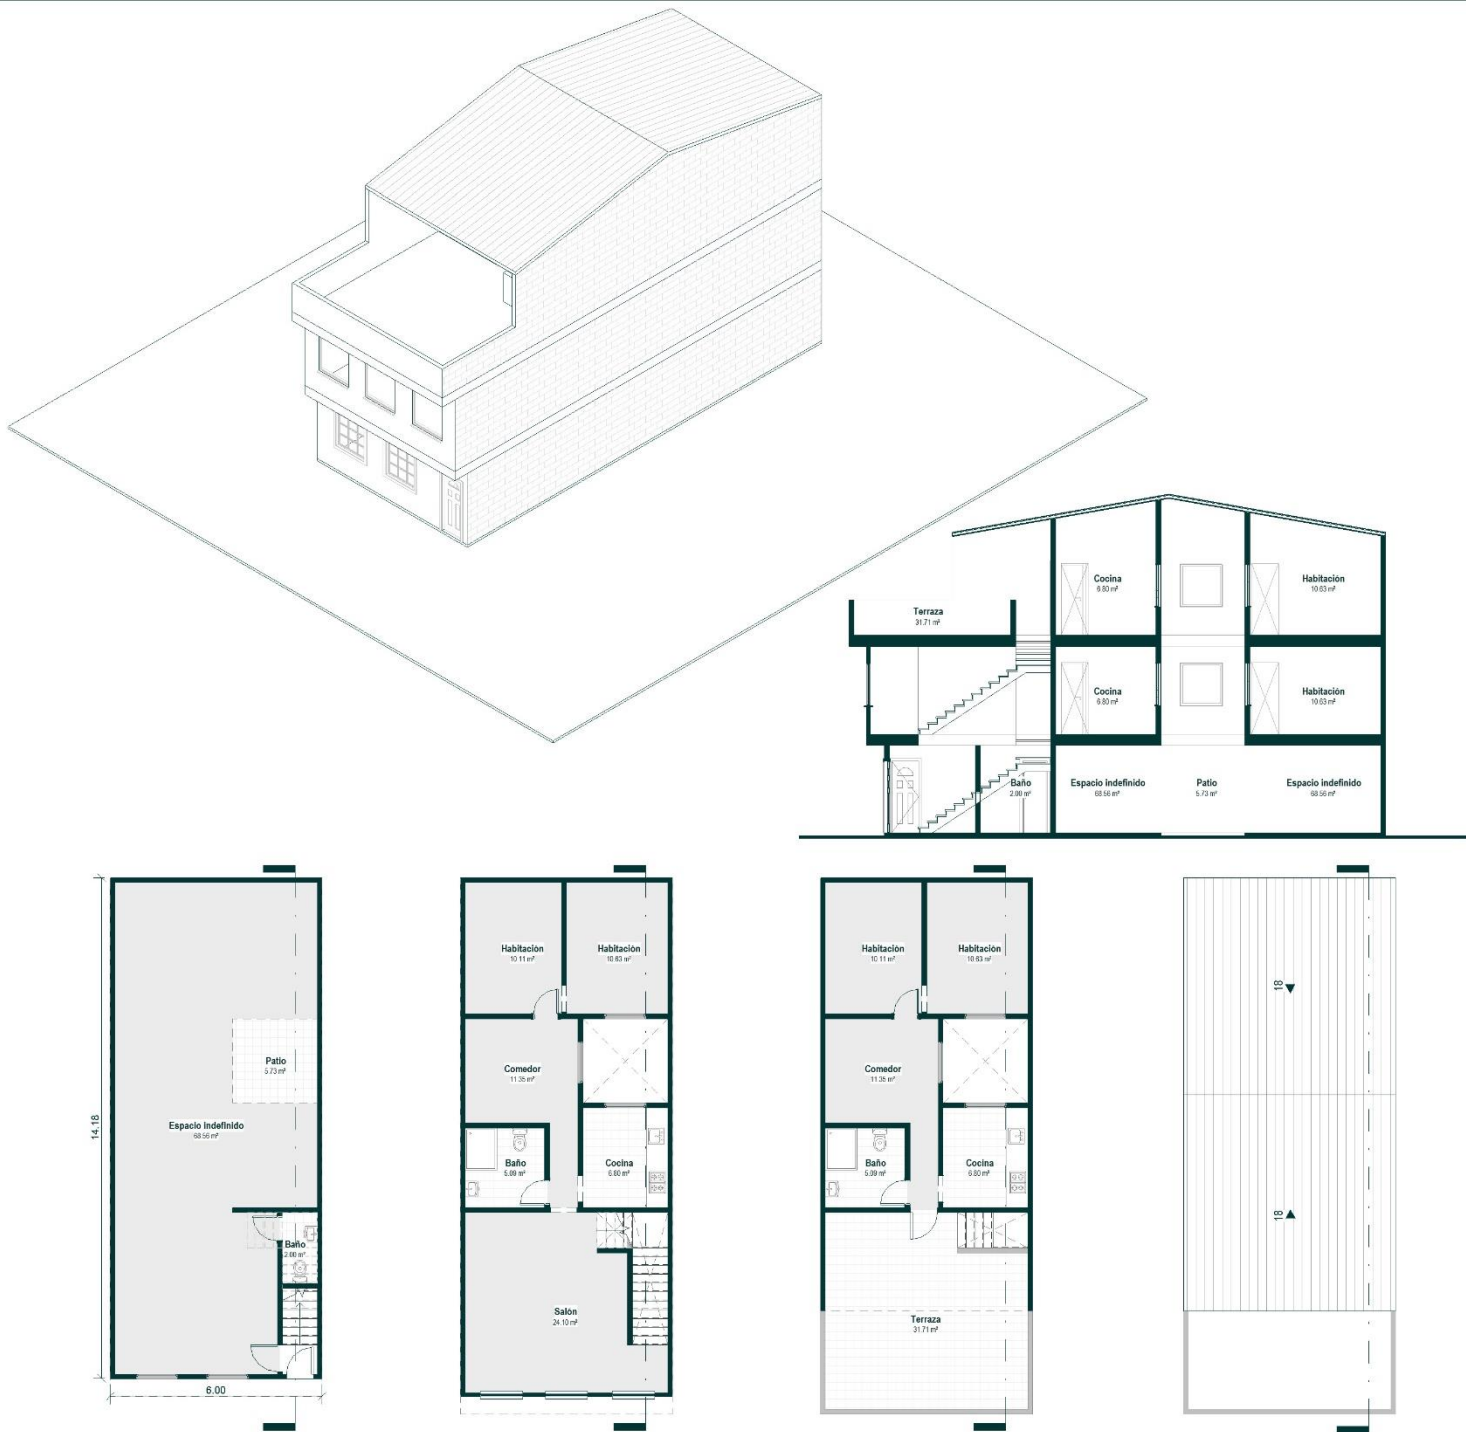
Vivienda con patio interior y escaleras aisladas por un espacio de productividad en planta baja, se identifica un mismo patrón espacial en planta primera y segunda, a excepción de un espacio de terraza que se mantiene abierto para una posible ampliación. *Elaboración propia a partir de* (Tarchópulos Sierra & Ceballos Ramos, 2003; Torres Tovar, 2009).
